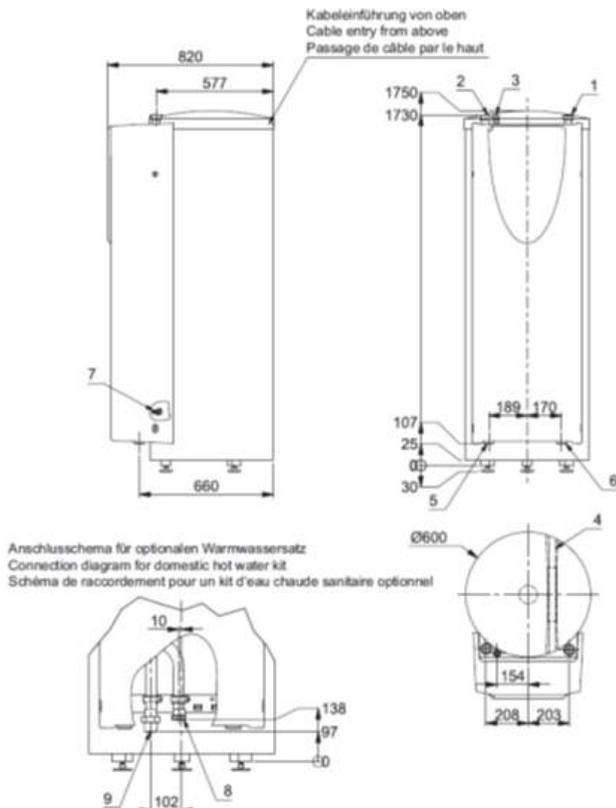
Aufbau Hydraulik-Tower HPK 300
